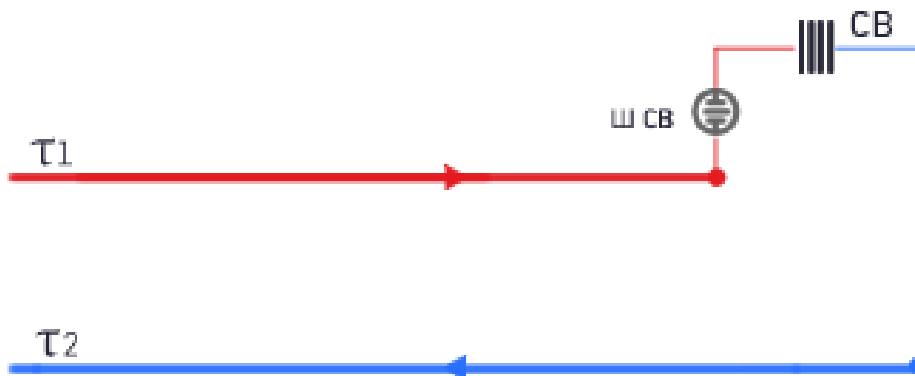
Схема №25. Потребитель с вентиляционной нагрузкой
